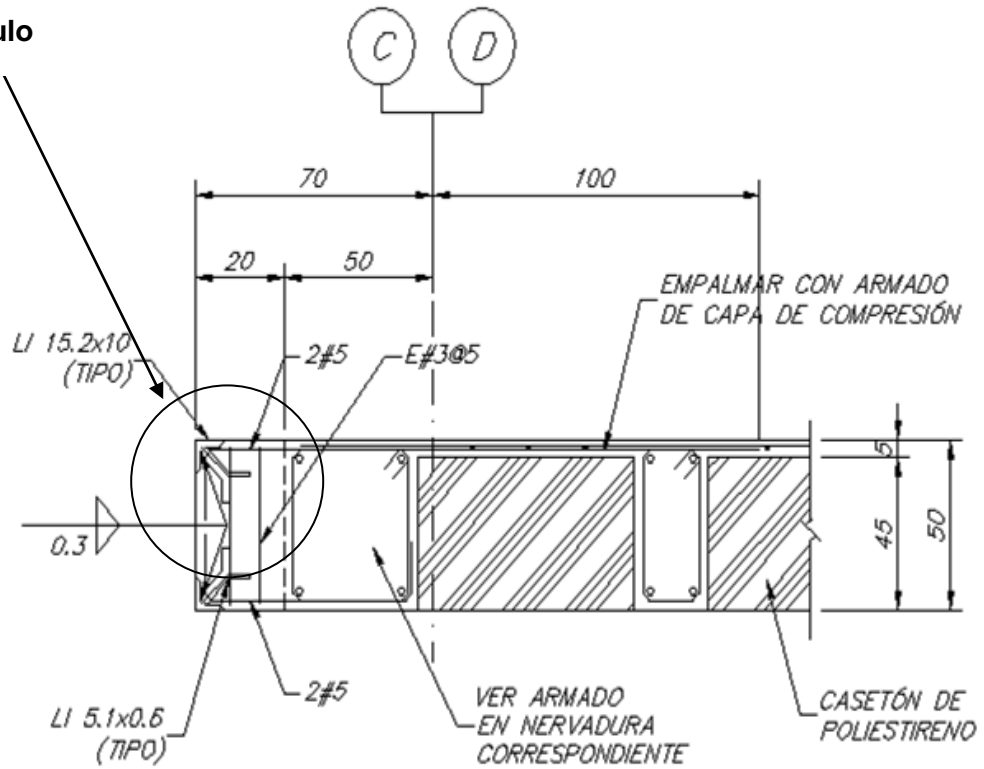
Ángulos para apoyo de prefabricados en nervadura
